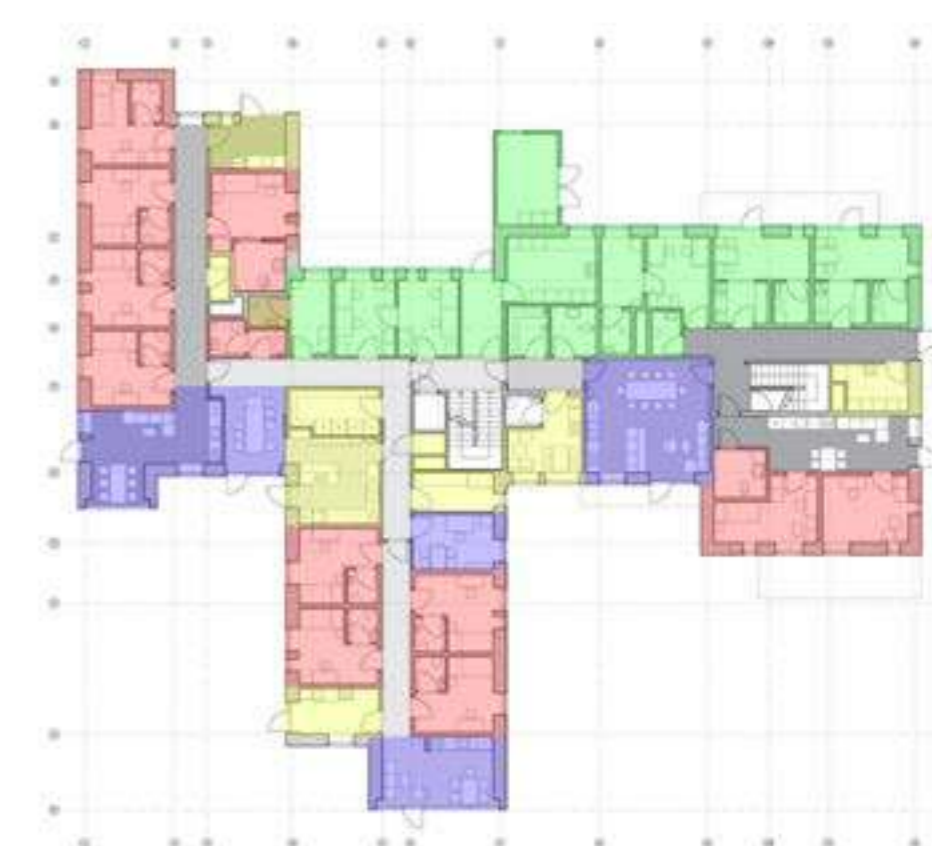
Planta do Pav. Térreo. Fonte: Archdaily
